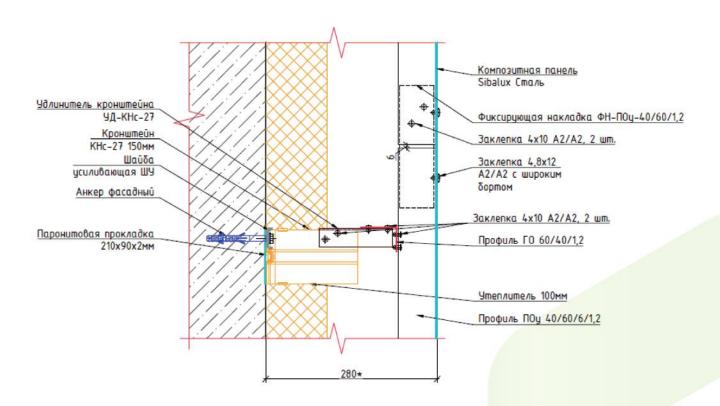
Вертикальный разрез навесной фасадной системы (на примере Альт-Фасад-06) для п. 6
